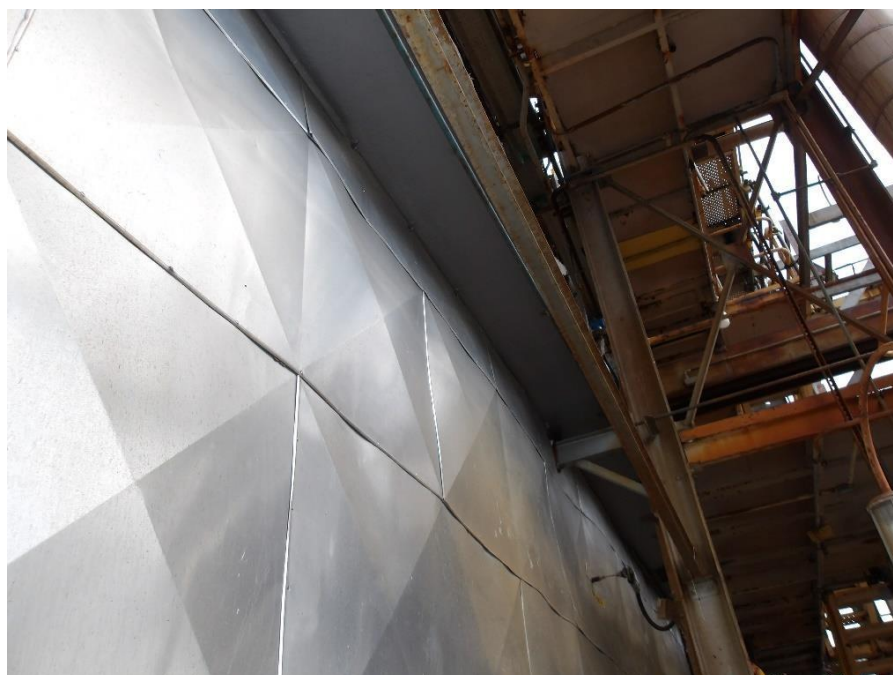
Detalhe de aplicação de isolamento térmico na região do Buckstaiyl parede leste.
